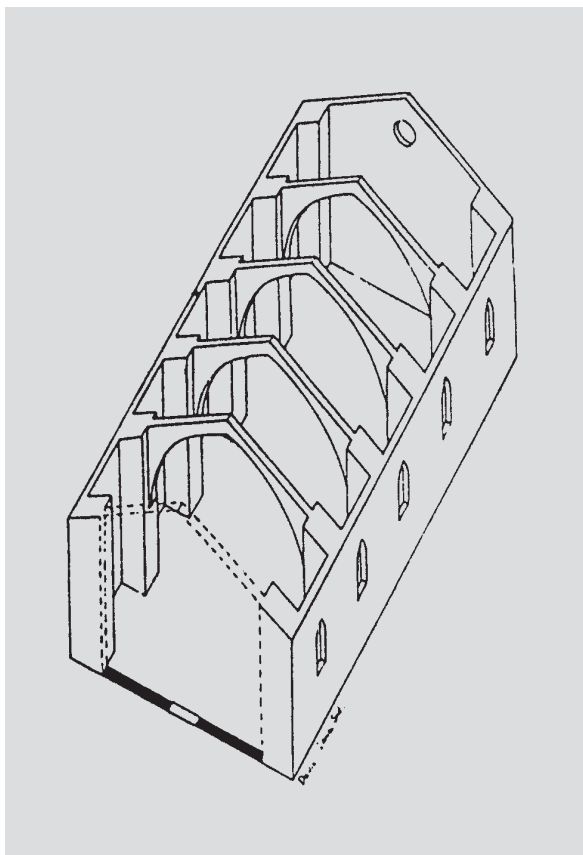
San Francisco de Barcelona (1236-1240). Reconstrucción hipotética de su alzado y planta según Anna M. Giné i Torres.
